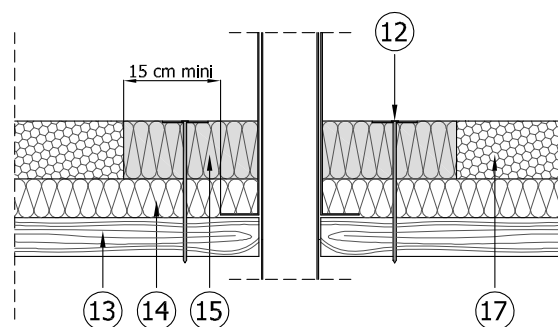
Raccordement des panneaux de la gamme TERMOTOIT en faitage et arêtier - appuis doubles
